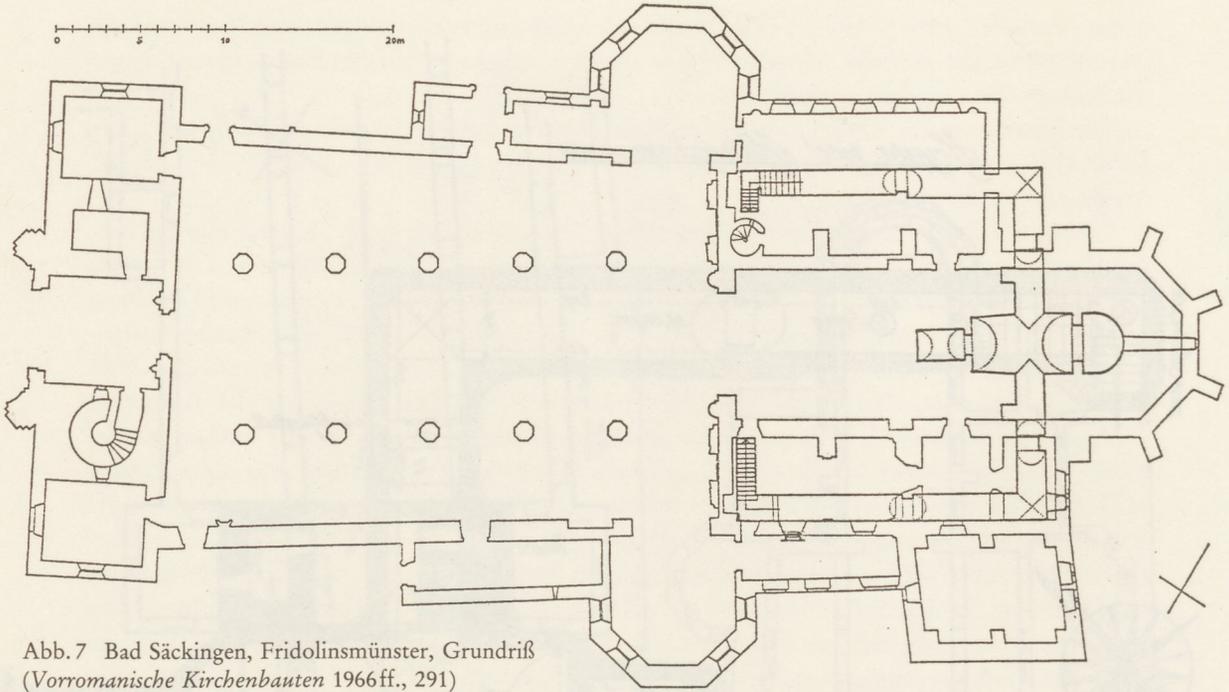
Bad Säckingen, Fridolinmünster, Grundriß
